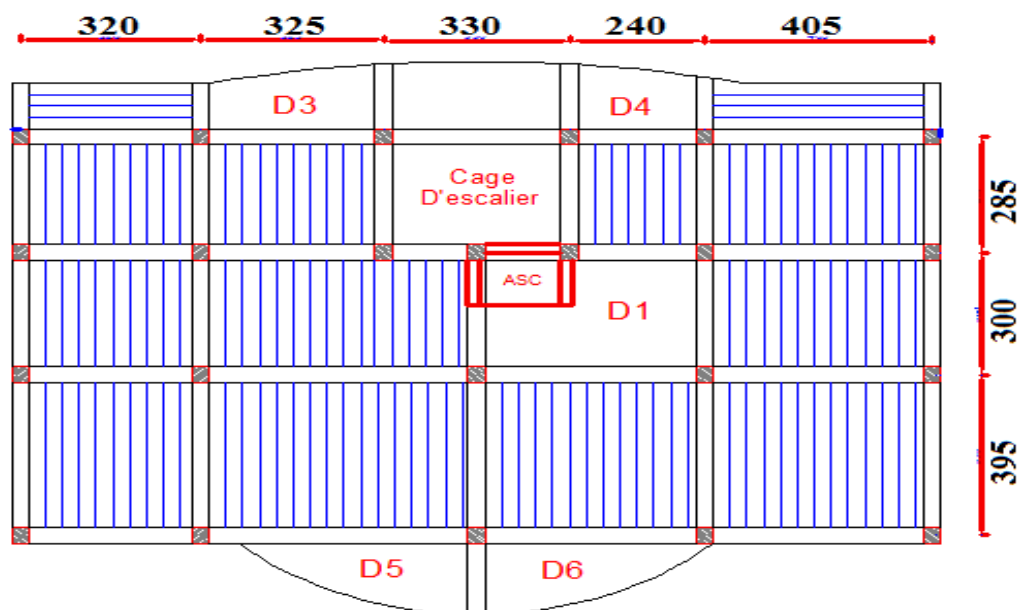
Schéma de la disposition des poutrelles des étages 1 à 8.
